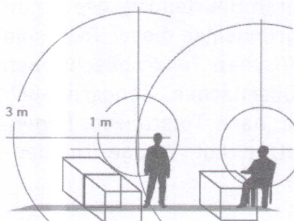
Betrachtungsabstände für Fußböden oder Treppen
